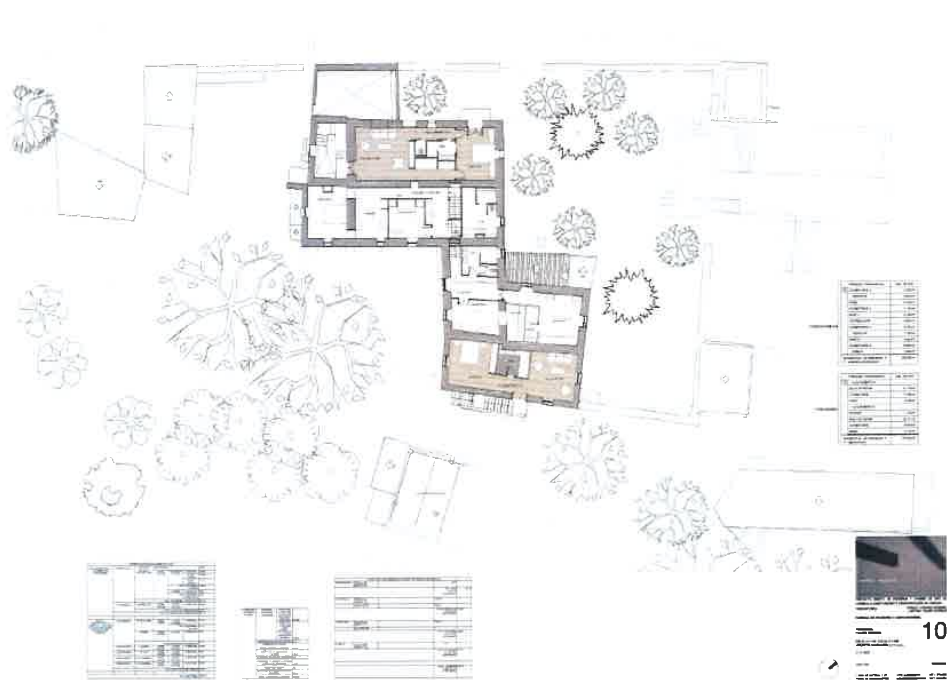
Agroturismo proyectado planta primera. Fuente: Juan Alba.
